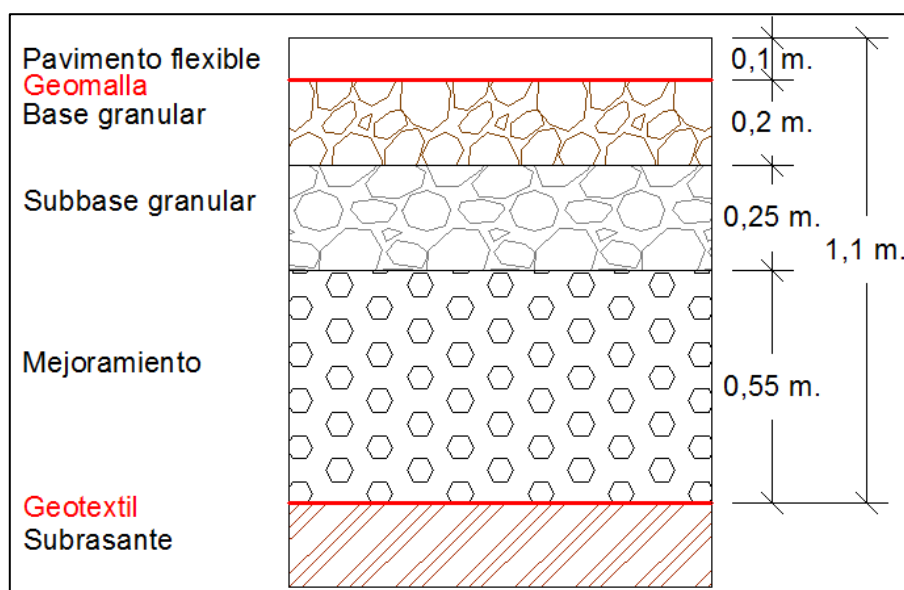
Nueva estructura de reposición con pavimento flexible
